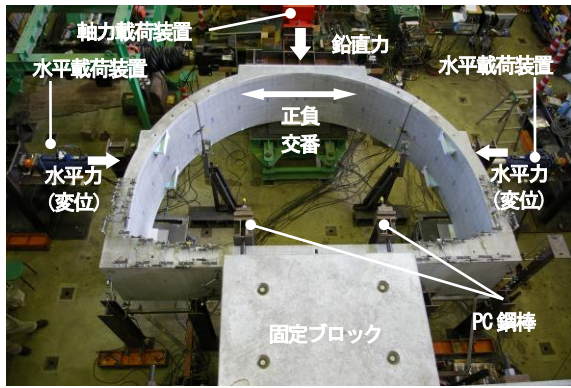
供試体設置概要写真 (2 ヒンジアーチ)
